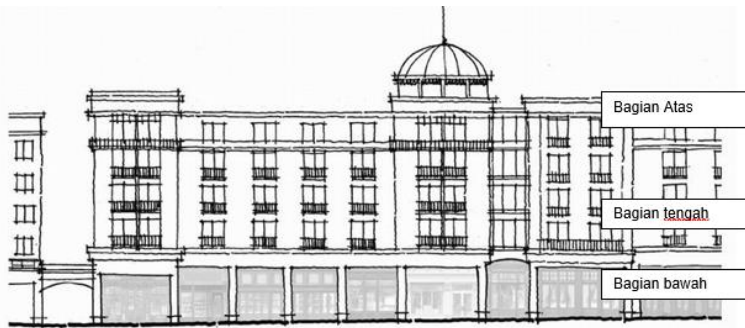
Sketsa contoh elemen desain bangunan.
